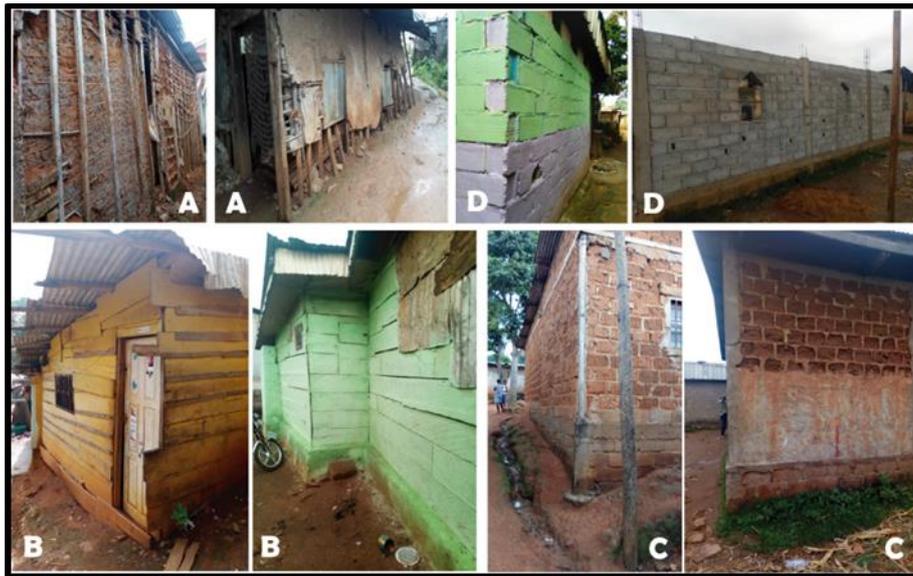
Maisons d'habitation en poto-poto (A), planches de bois (B), briques de terre crue (C) et parpaings de ciment (D)
